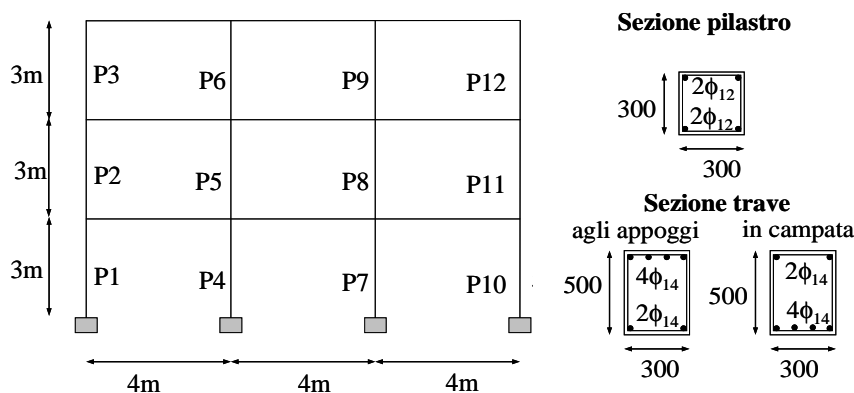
Telaio di progetto – Sezioni di travi e pilastri
